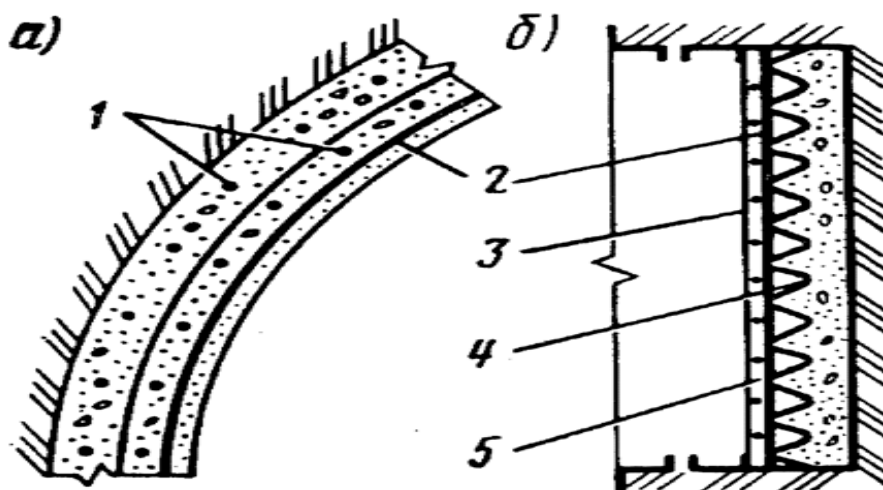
Металлическая гидроизоляция: *а* – для круговых обделок; *б* – для торцовых стен тоннелей; 1 – стержни арматурного каркаса; 2 – стальная оболочка; 3 – покрытие по металлоизоляции; 4 – зигзагообразная арматура; 5 – стальной лист
